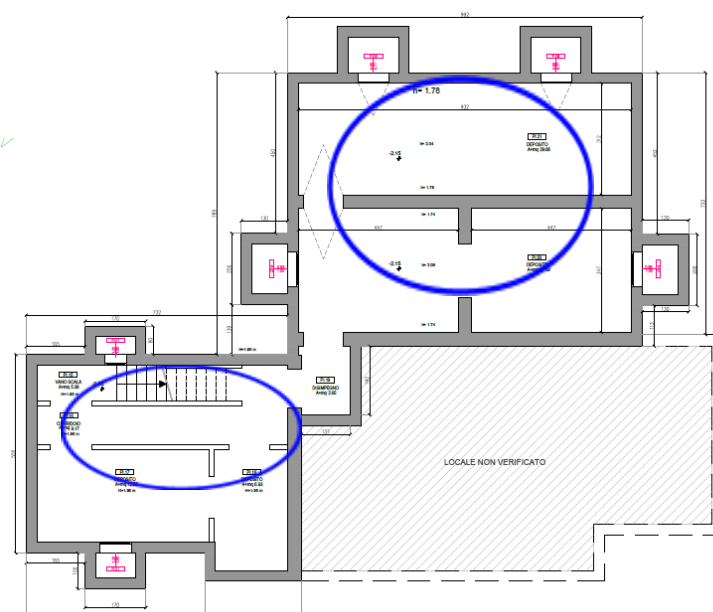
Planimetria piano interrato dell'edificio accessorio.
